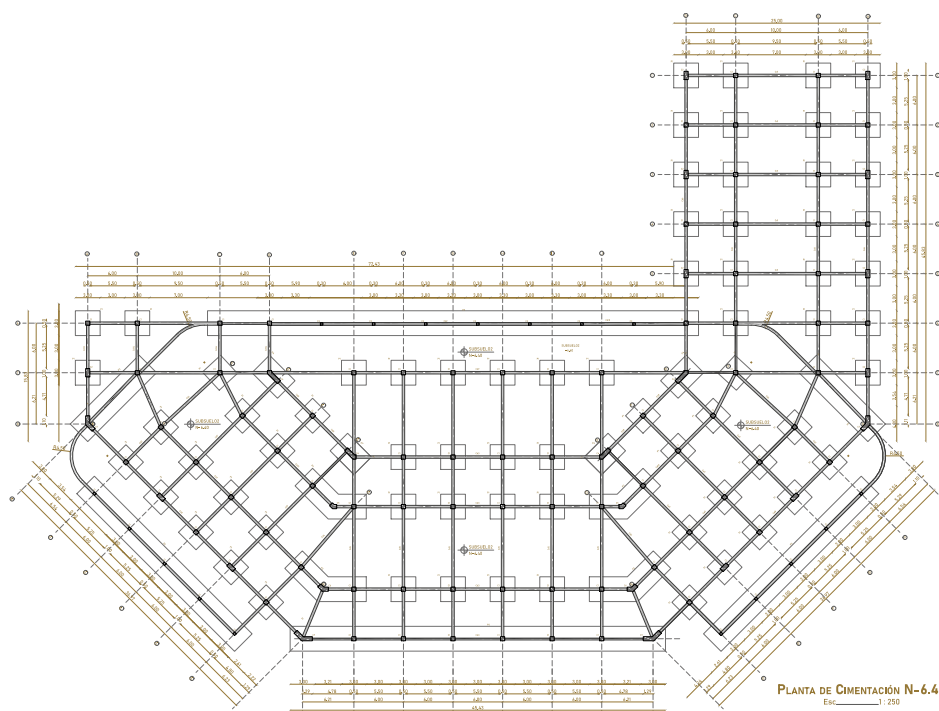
Planta de Cimentación Fuente: Elaboración Propia
